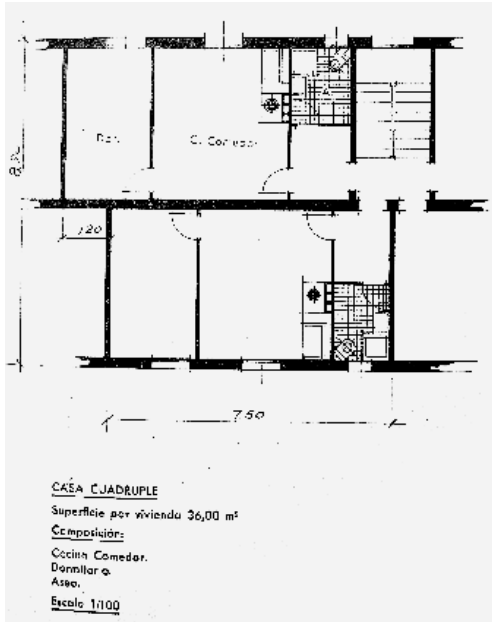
º. Esquema de una planta de 36 m2. Pág. 16
